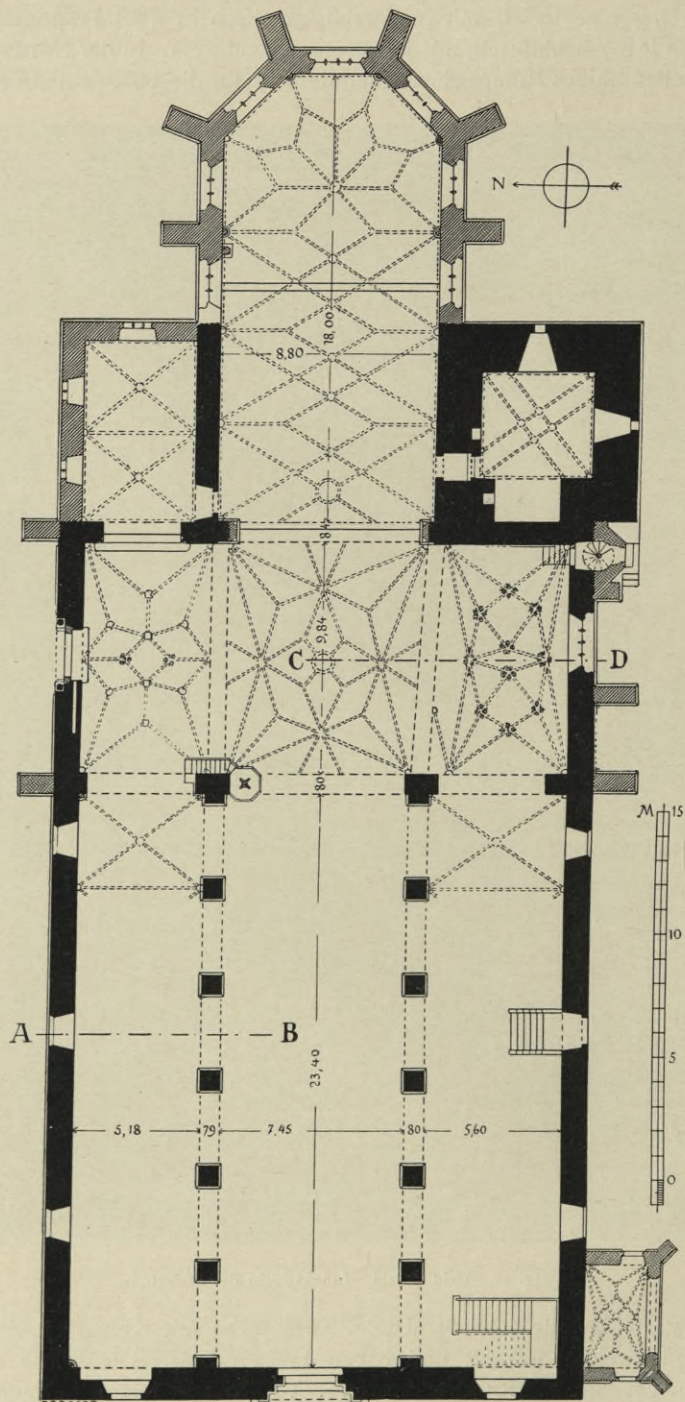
Heidingsfeld. Grundriß der Pfarrkirche.
